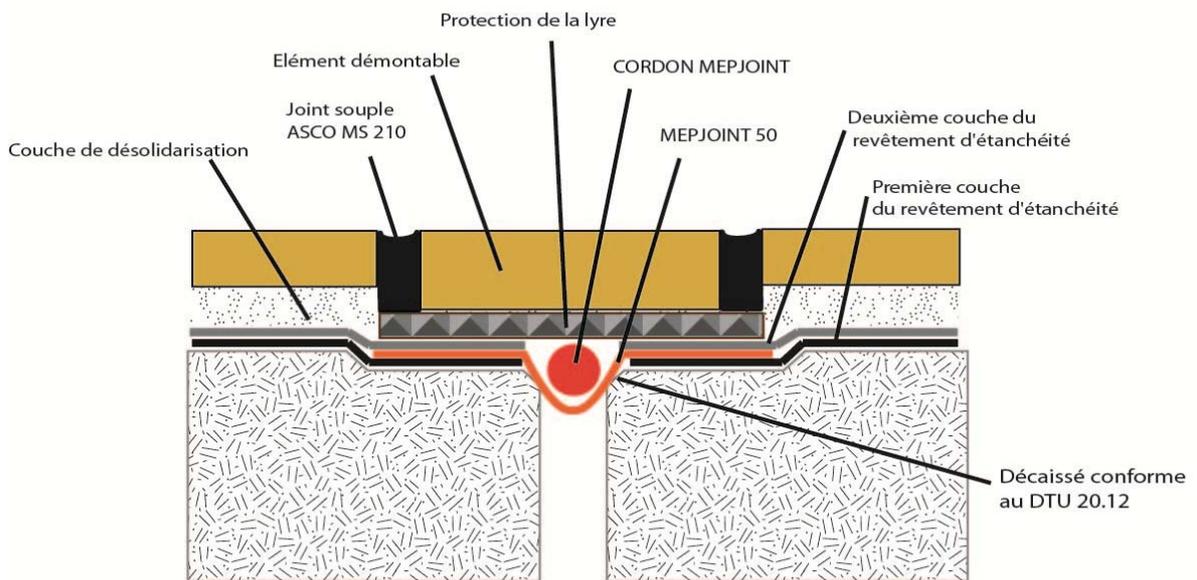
Exemple de joint plat en partie courante raccordé à une étanchéité bicouche en bitume modifié cf. § 4.41
